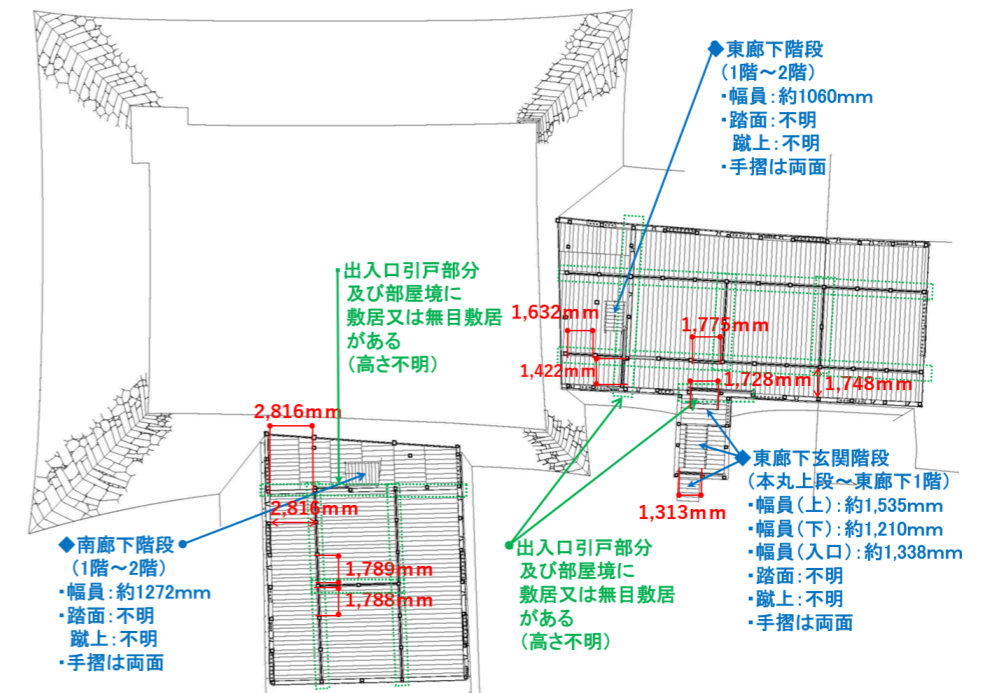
東廊下・南廊下 1 階平面図（復元原案）
